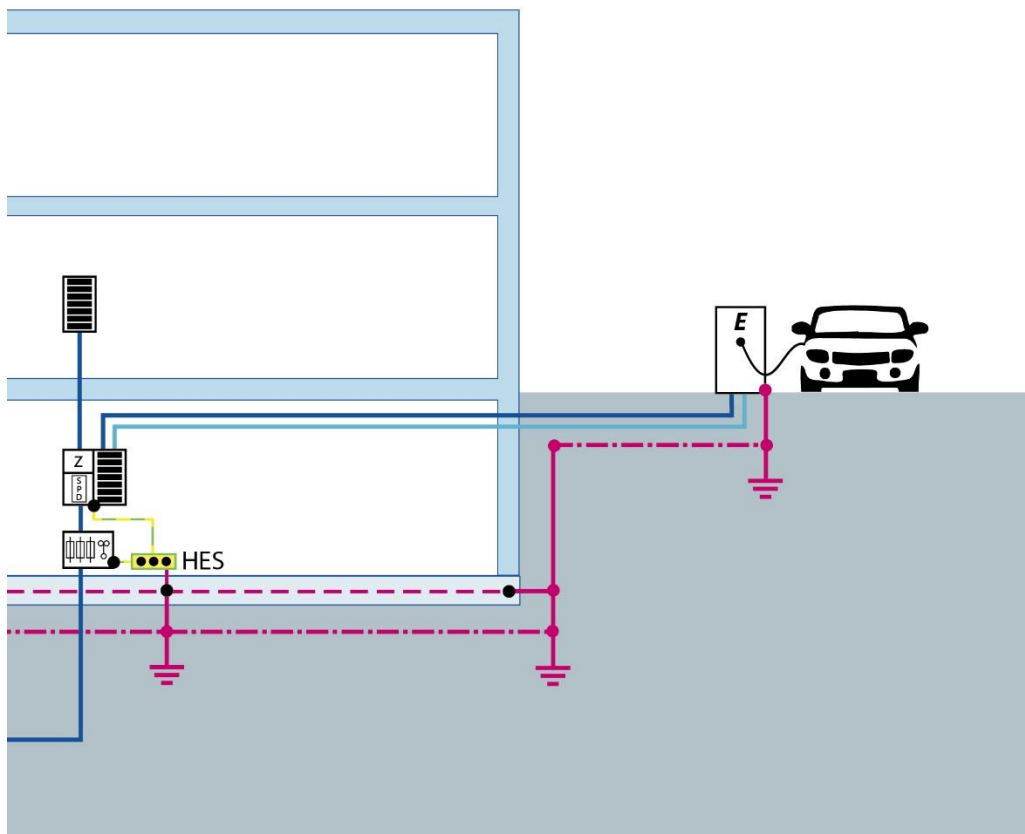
Gebäude, Kundenanlage mit Ladeeinrichtung für Stellplatz außerhalb des Gebäudes
